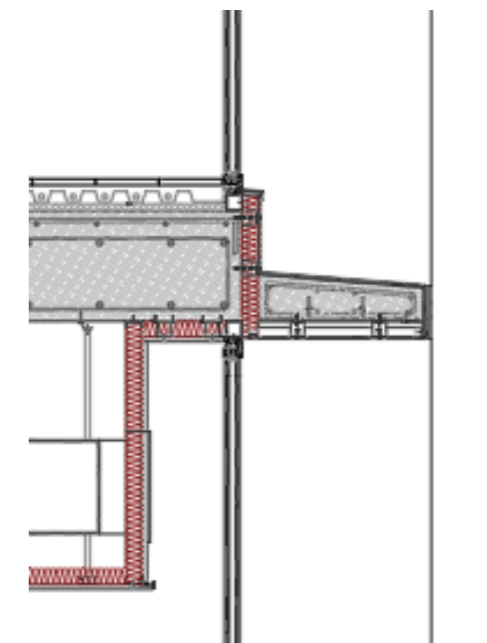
ENCUESTRO FORJADO - FACHADA
